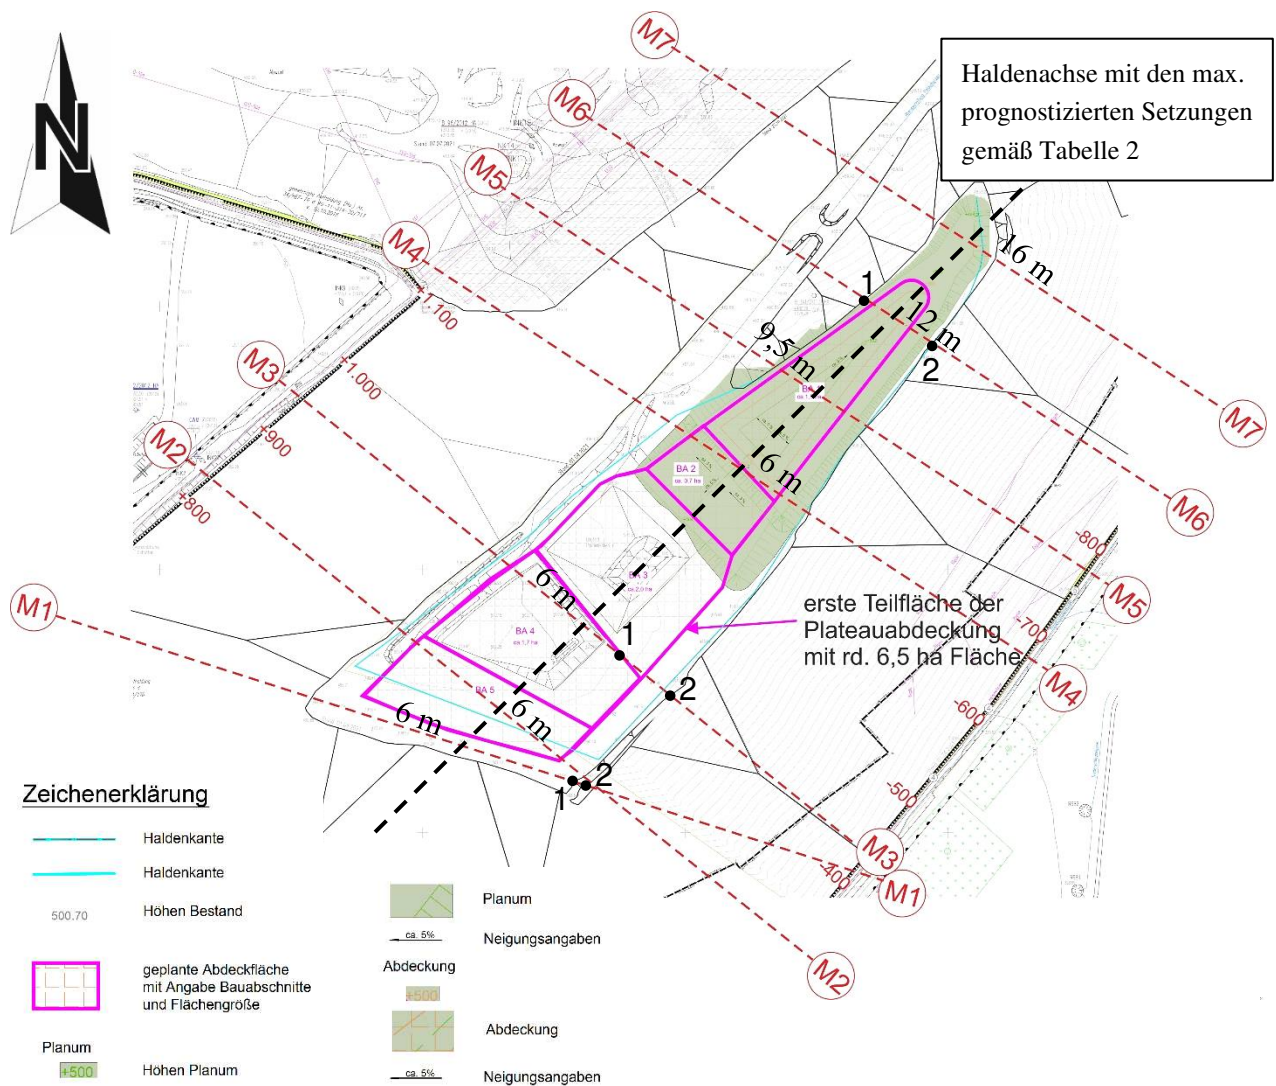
Lageplan der bestehenden Halde Hattorf mit geplanter Plateaubedeckung und den messtechnisch überwachten Schnitten M1 bis M7 [U1] sowie den prognostizierten Setzungen (Betrachtungszeitraum 2021 bis 2041).
